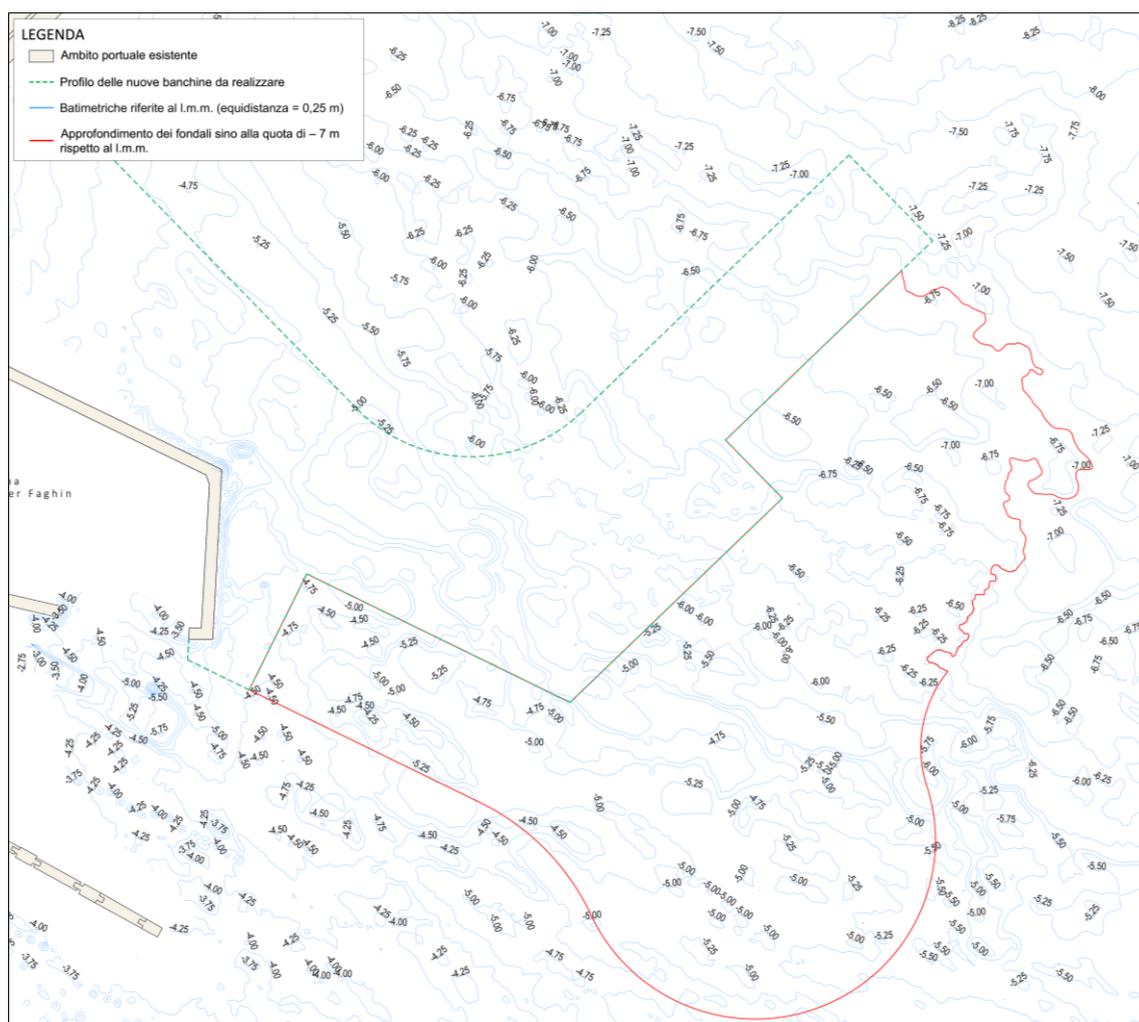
Planimetria con l'individuazione dell'area oggetto di approfondimento dei fondali
